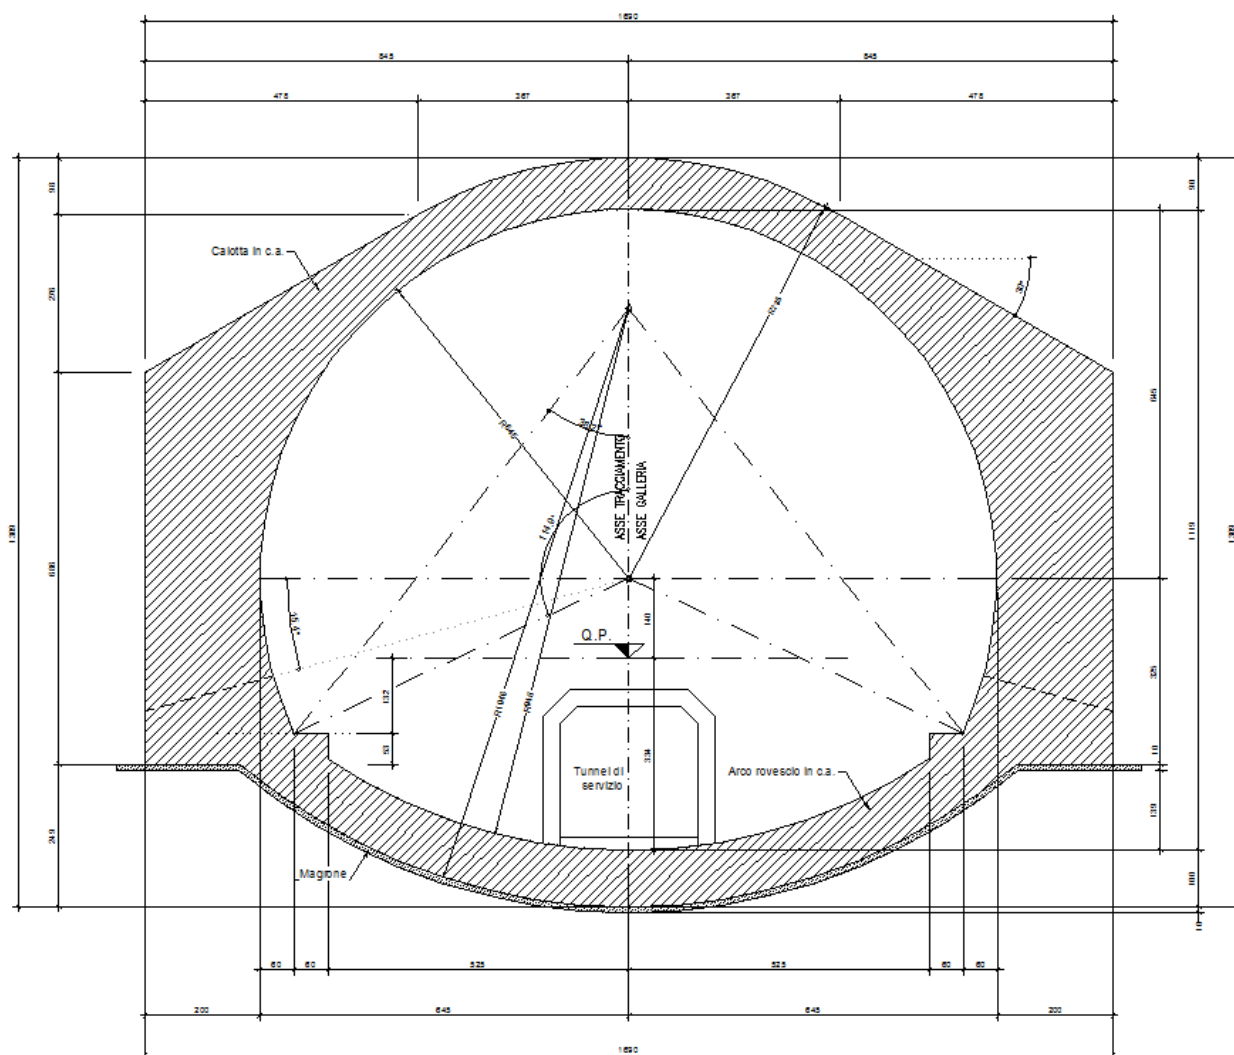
SEZIONE TRASVERSALE GALLERIA ARTIFICIALE
